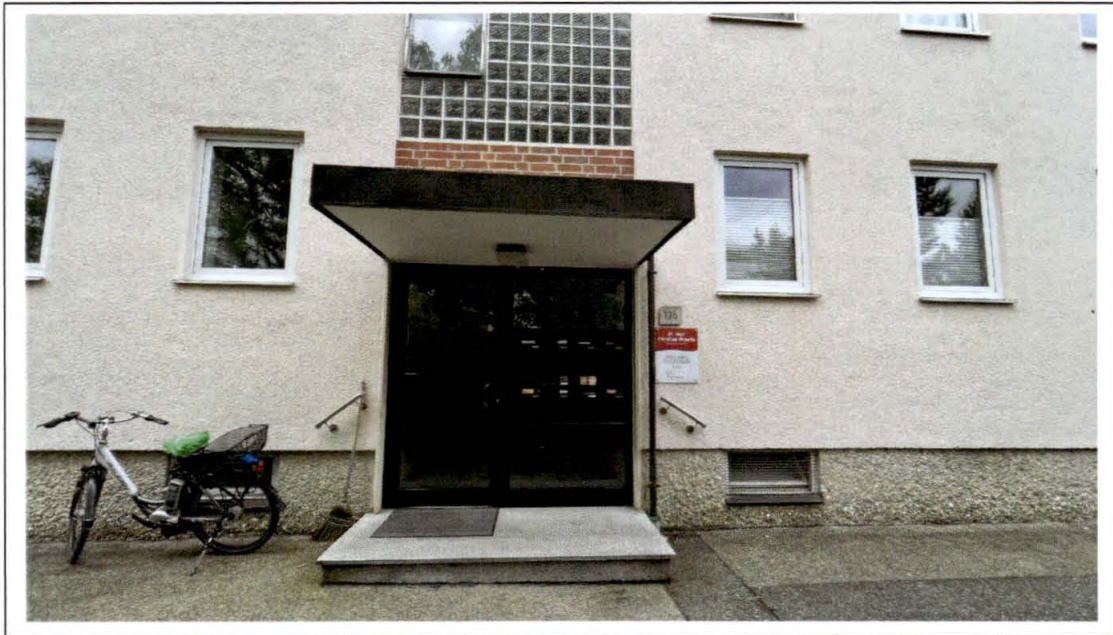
Hauseingang Nr. 10 b - Ansicht von Osten
